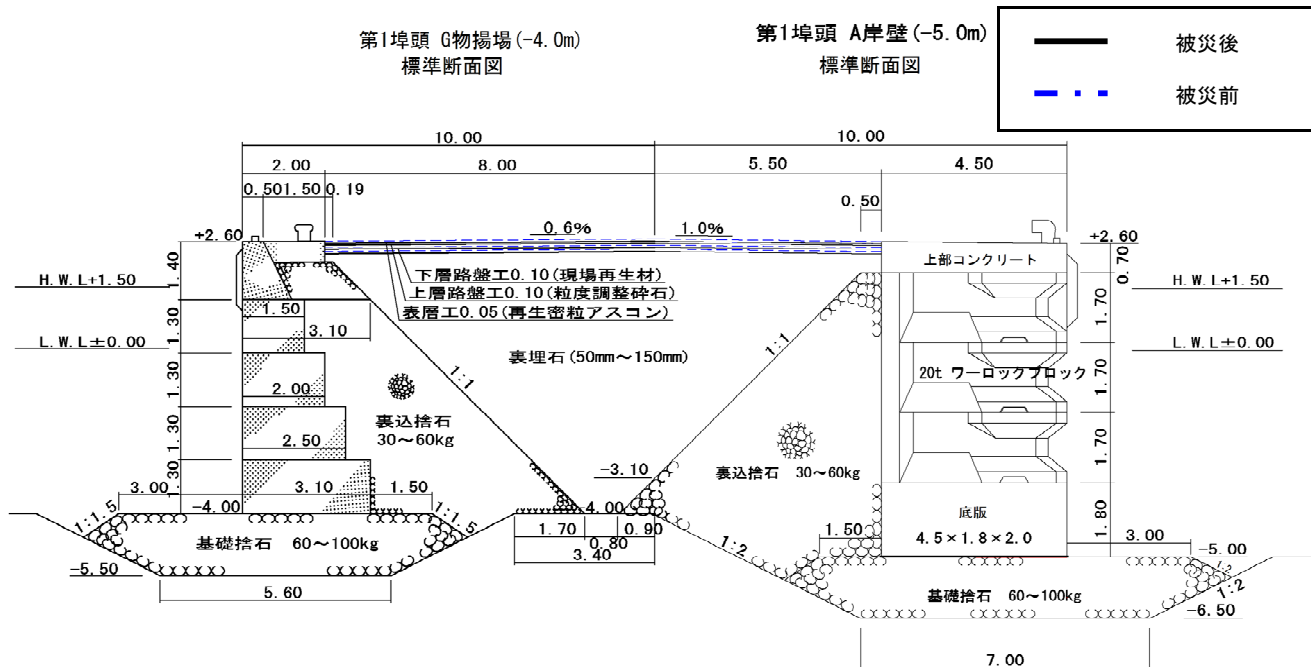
No.28 大洗港区\_第1埠頭地区 A岸壁の断面図 (被災後)
